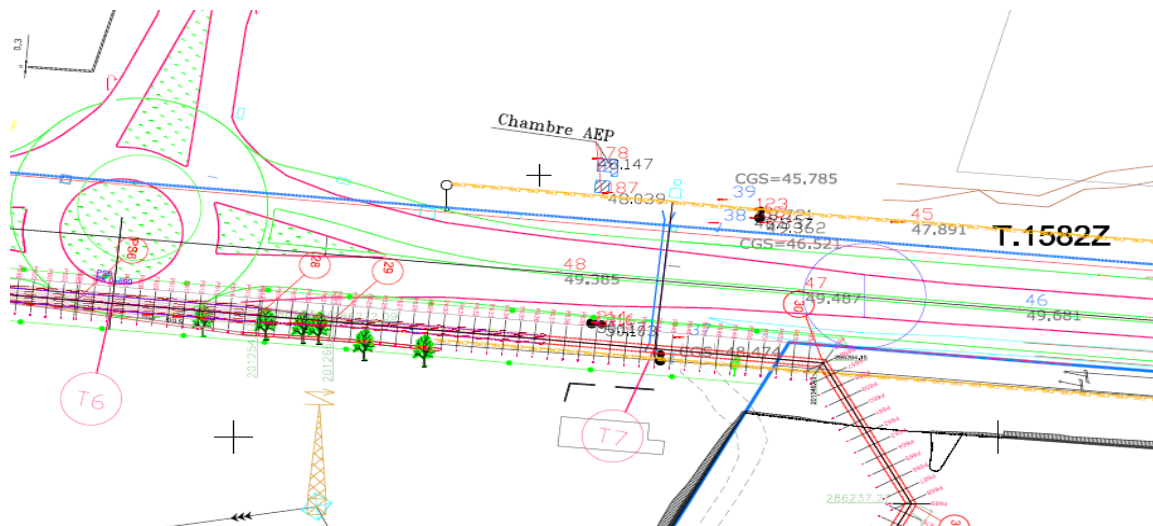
Le tracé en plan montre l'existence d'une chambre AEP (Alimentation en eau potable) et des conduites sous pression dans la zone 1.
